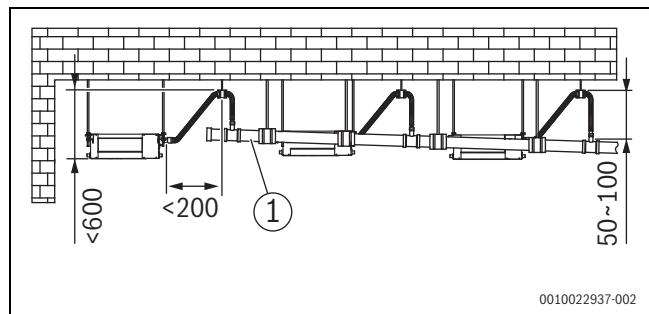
Installation und Abstände der Ablauflleitung bei Installationen mit Kondensatpumpe [mm]
